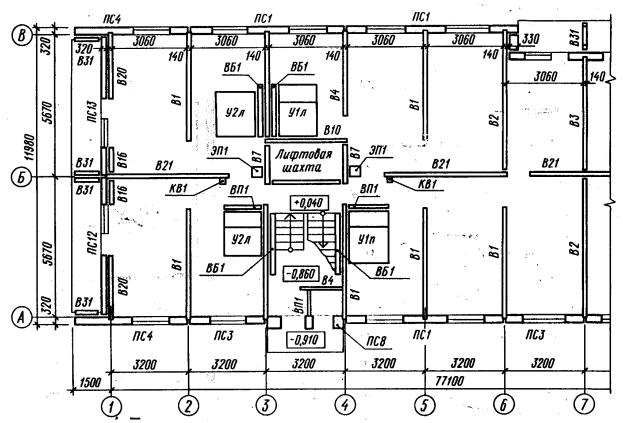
Схема расположения панелей на плане 1-го этажа жилого дома
